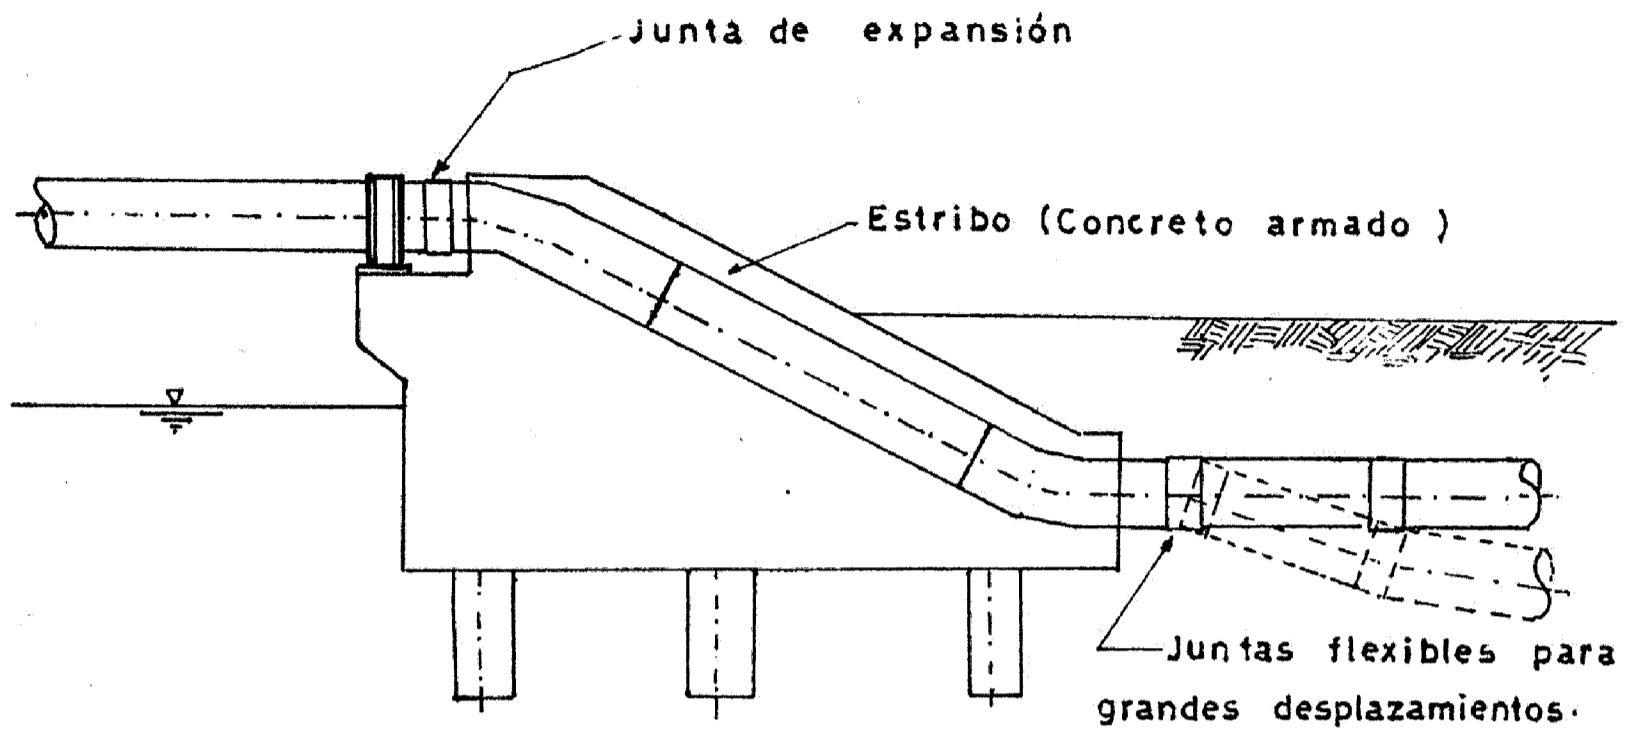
CONEXION DEL TUBO AL ESTRIBO
